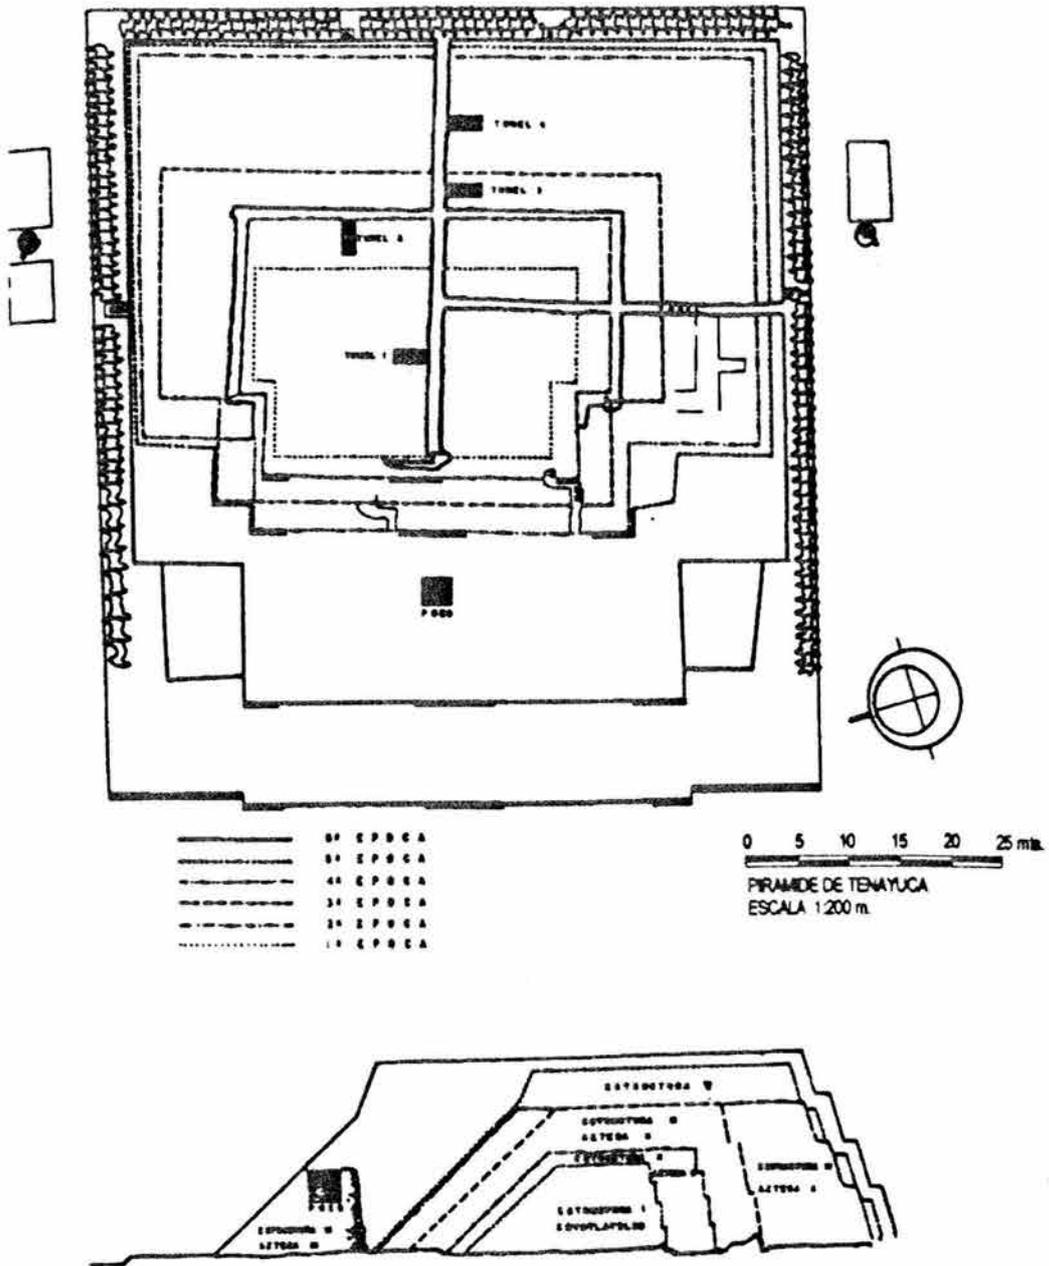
Planta y corte de la pirámide de Tenayuca donde se observan las diferentes Sub-estructuras (Redibujadas de Acosta 1965).
